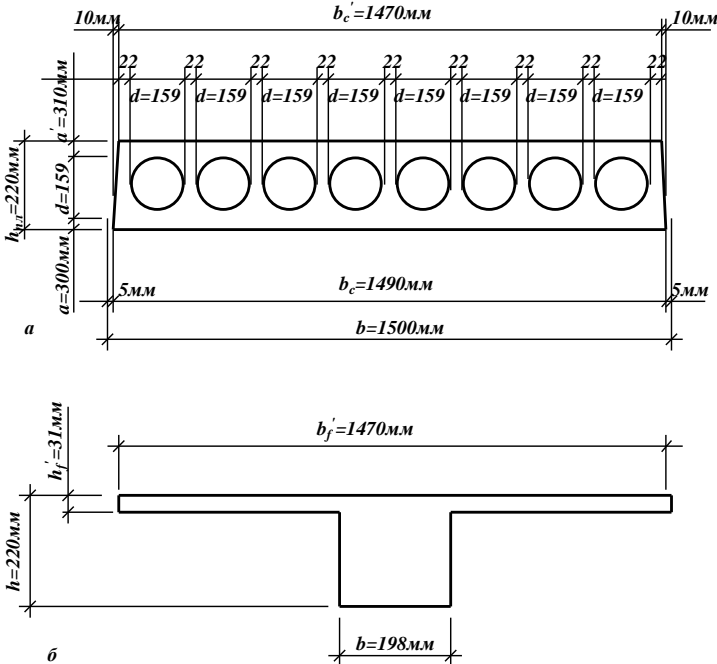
Дійсний (а) і розрахунковий (б) перерізи плити перекриття з круглими порожнинами шириною 1,5м
